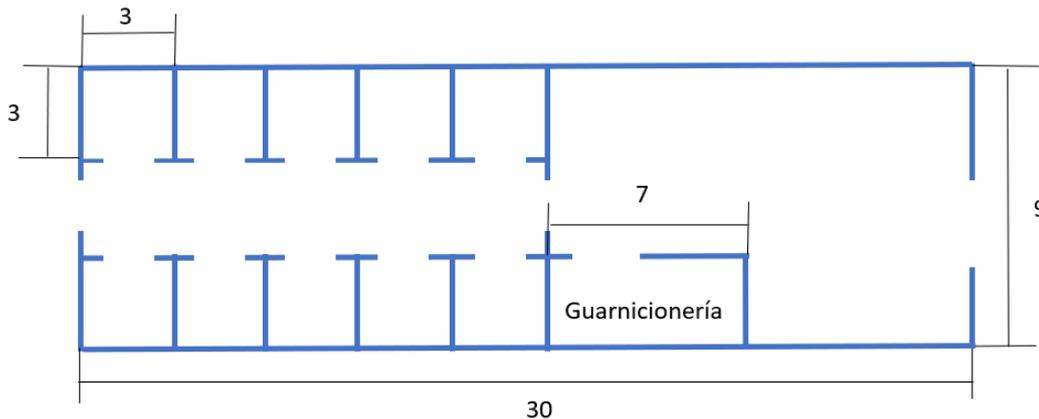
Croquis ilustrativo de la distribución en planta de las cuadras para los mulos.
